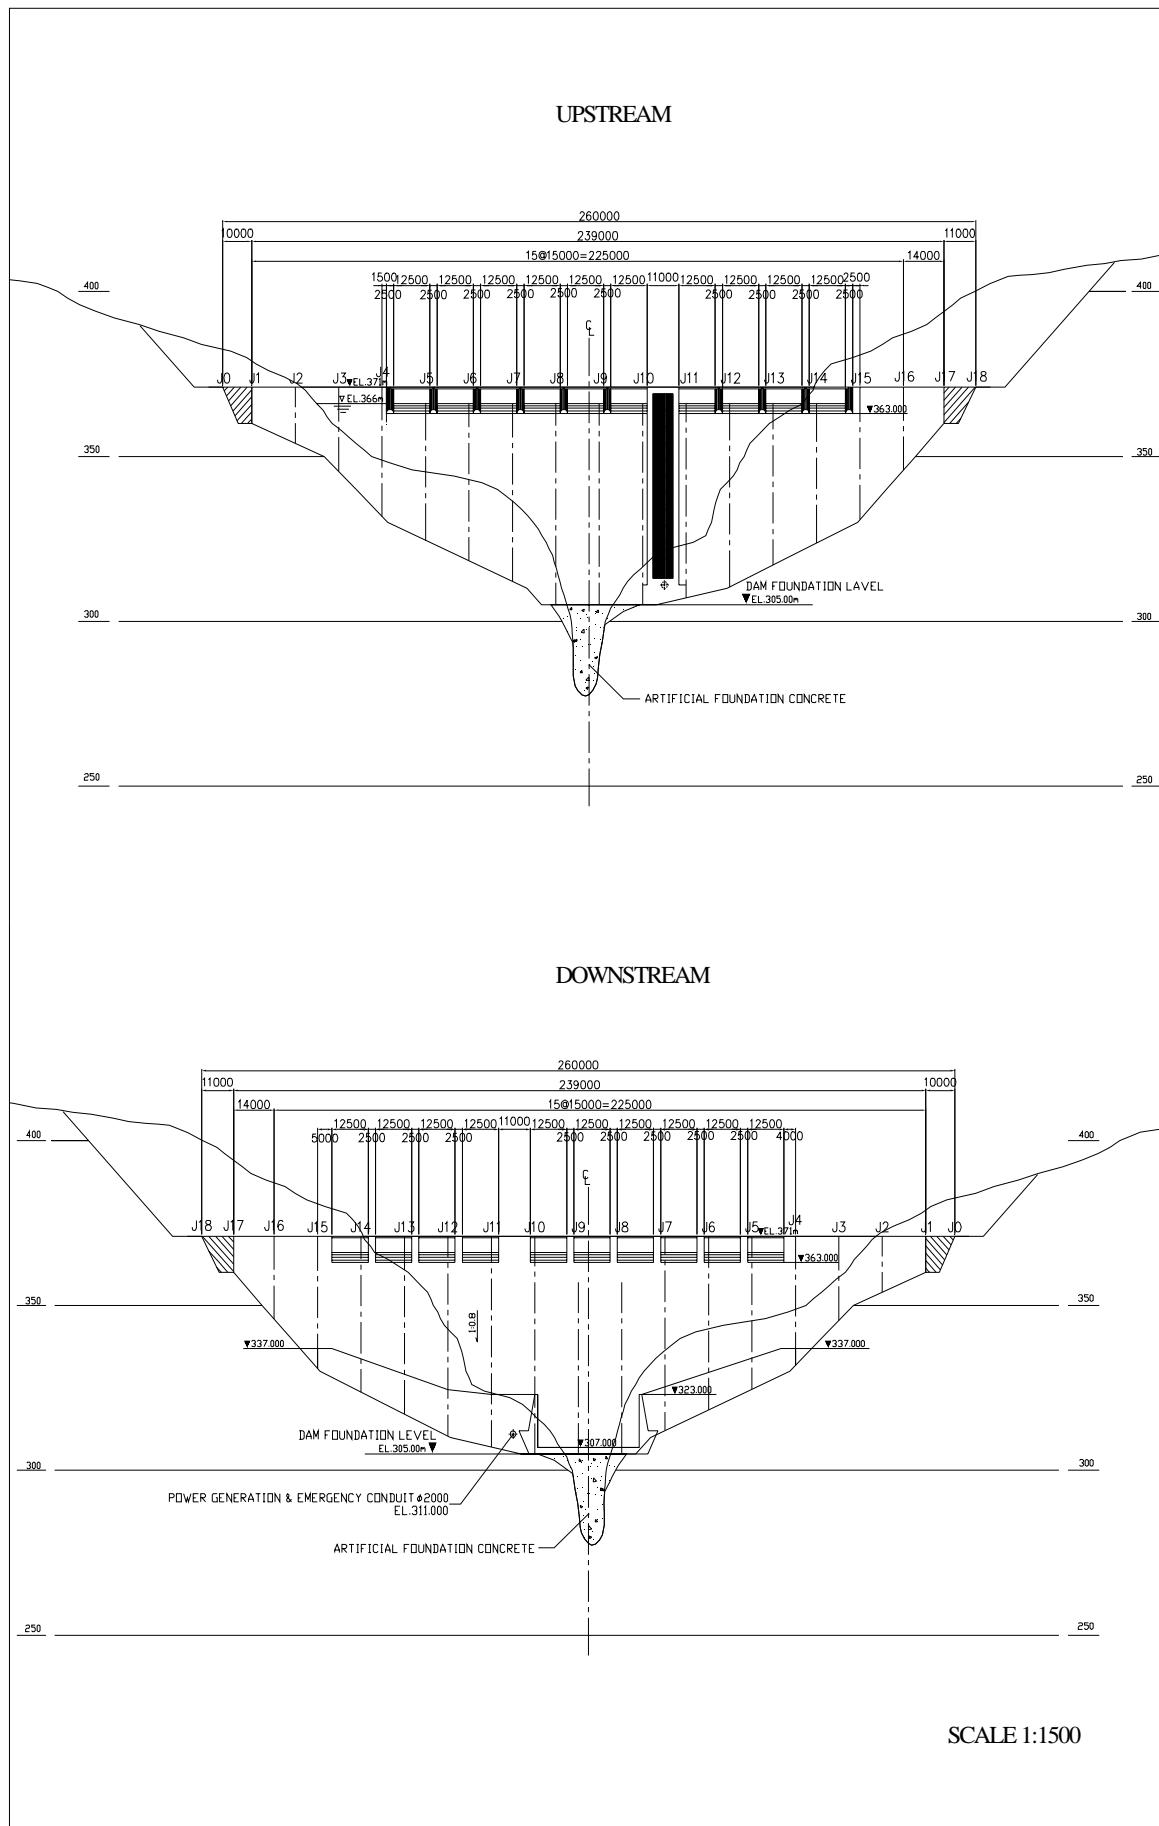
Rencana Umum untuk Dam Ayung and Reservoar
